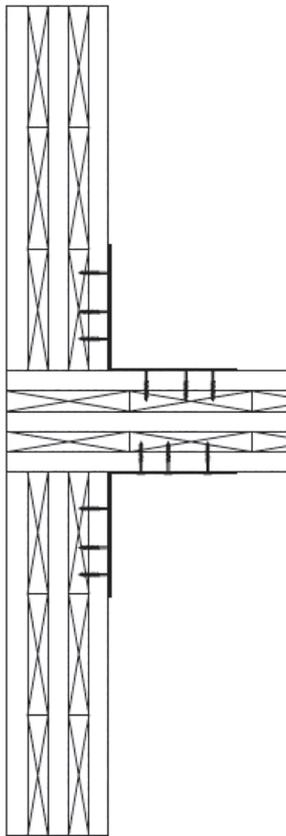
Assemblage mur-plancher par connecteurs tridimensionnels
